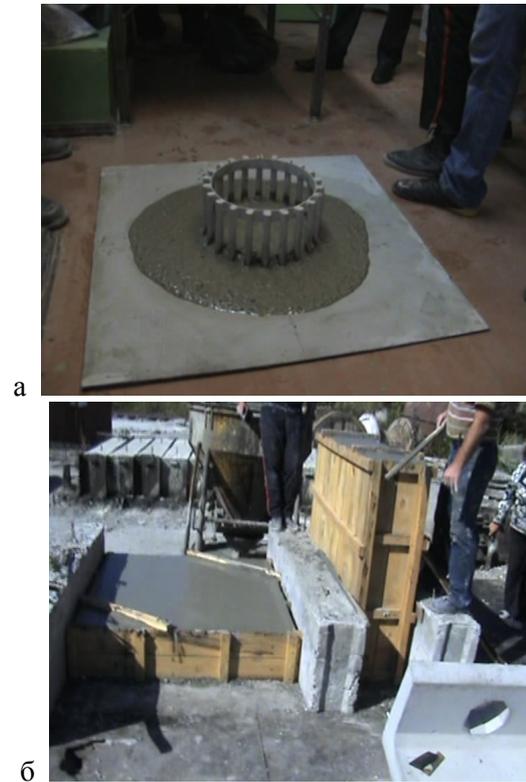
Бетонирование облегченных конструкций с применением СУБ: а – лабораторные испытания бетонной смеси; б – бетонирование горизонтального и вертикального элементов
